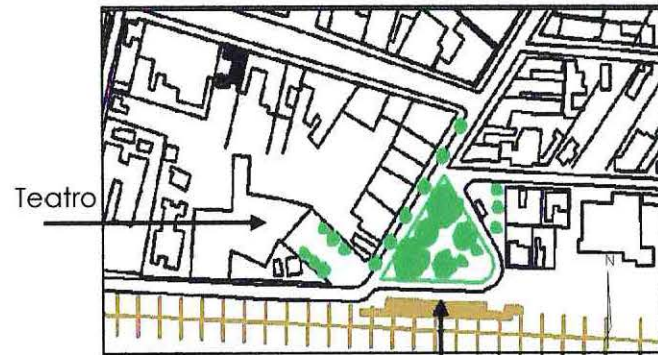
Gradería que eleva el andén hacia la plaza destacando el edificio
